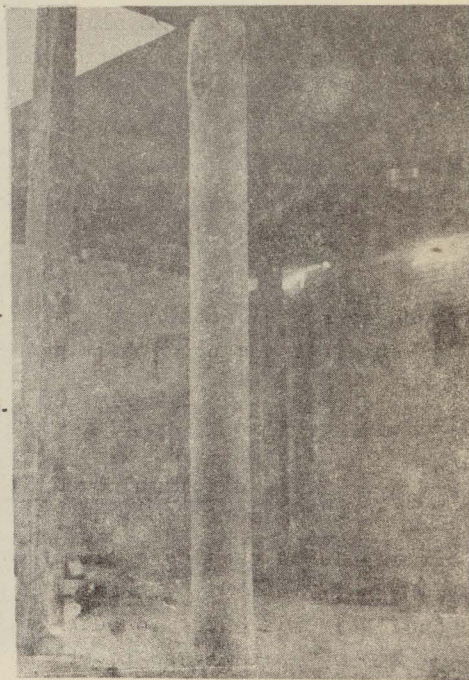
Delgada columna de la construcción de la fig. 22, degollada abajo y arriba. Soportaba únicamente una losa delgada, cuyo peso no era excesivo. El diseño era deficiente y la mano de obra, pobre.
